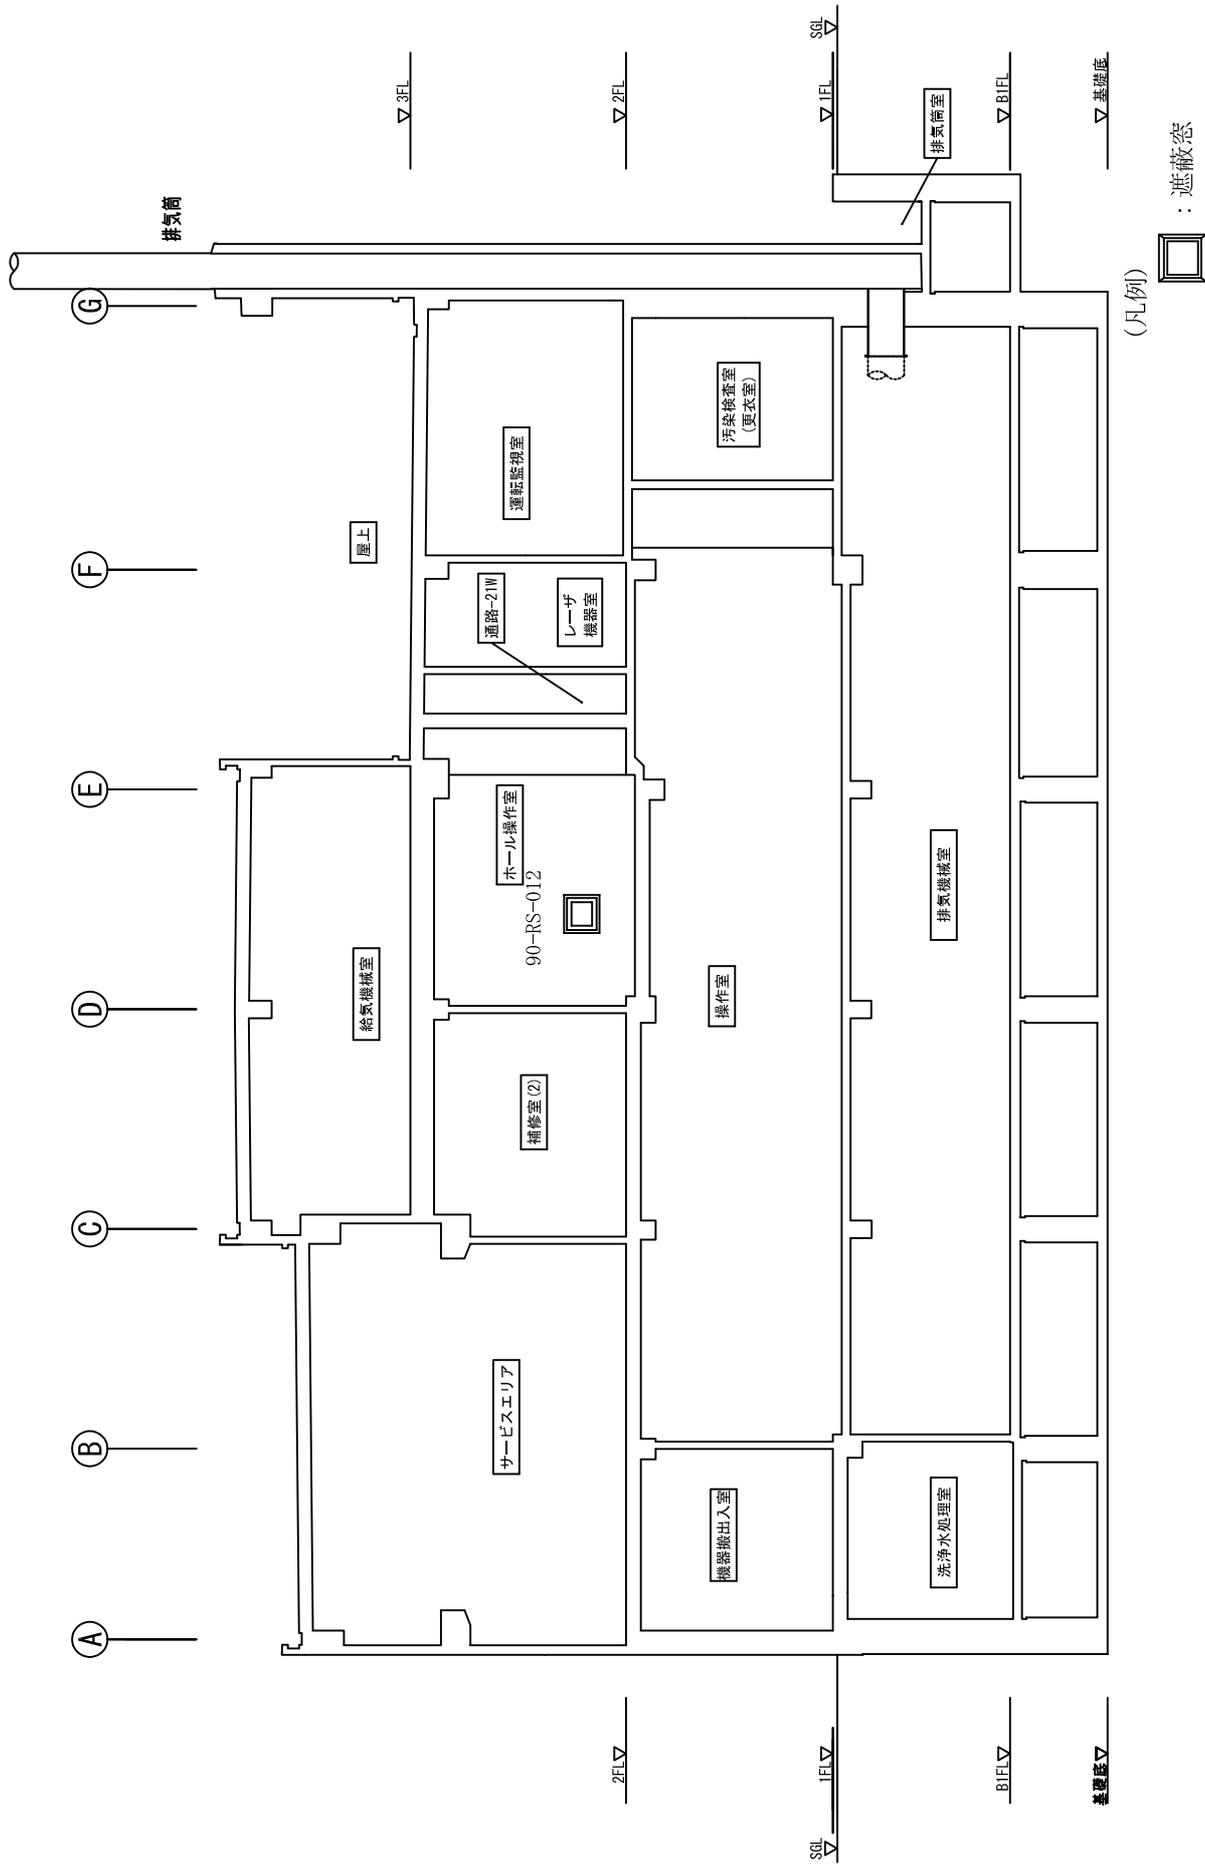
遮蔽窓-1配置図 (④～⑤間断面図)
